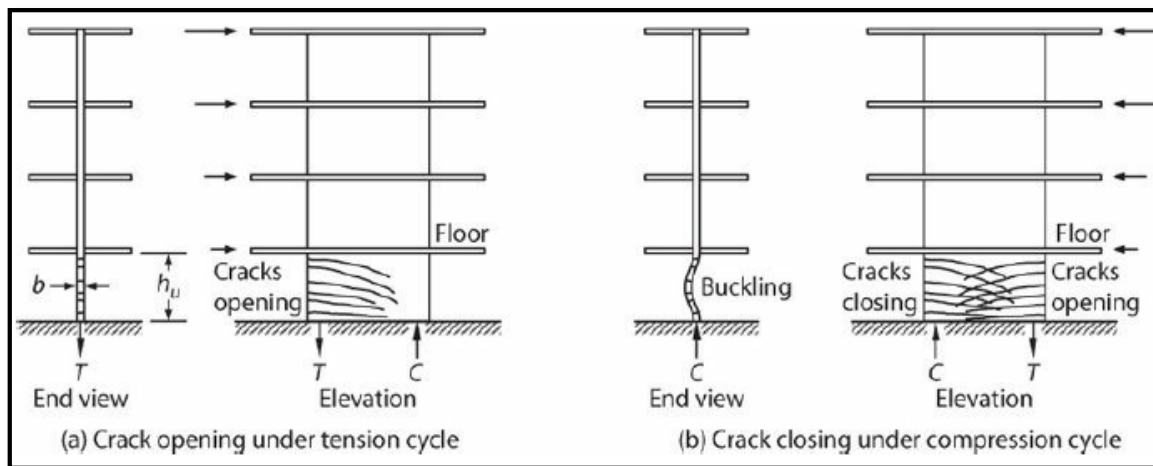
Pandeo lateral influenciado por grietas de tracción (Moehle, 2014)
